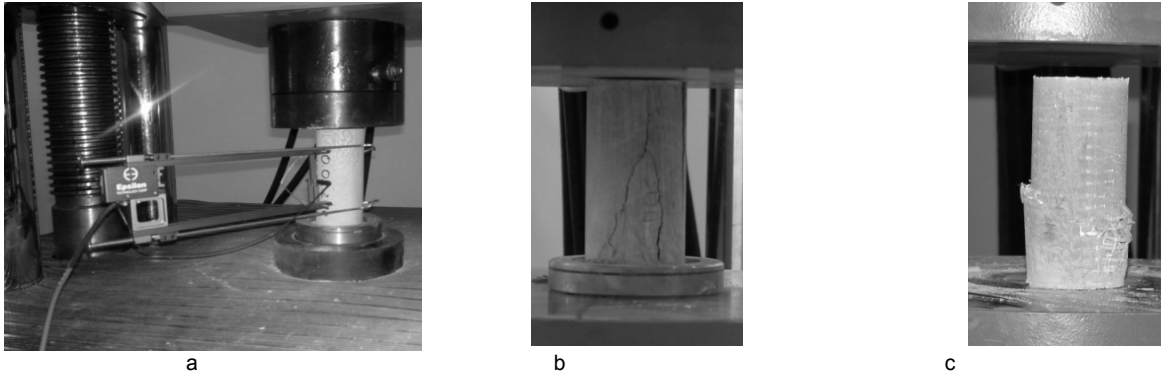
Încercarea la compresiune pe epruvete cilindrice / *Compression test on cylindrical samples*: (a) – epruveta cilindrică echipată cu extensometru / *the cylindrical specimen equipped with extensometer*; (b) – cedarea la compresiune a epruvetei nearmate / *compressive failure of a unreinforced specimen*; (c) - cedarea la compresiune a epruvetei armate / *compressive failure of a reinforced specimen*.
